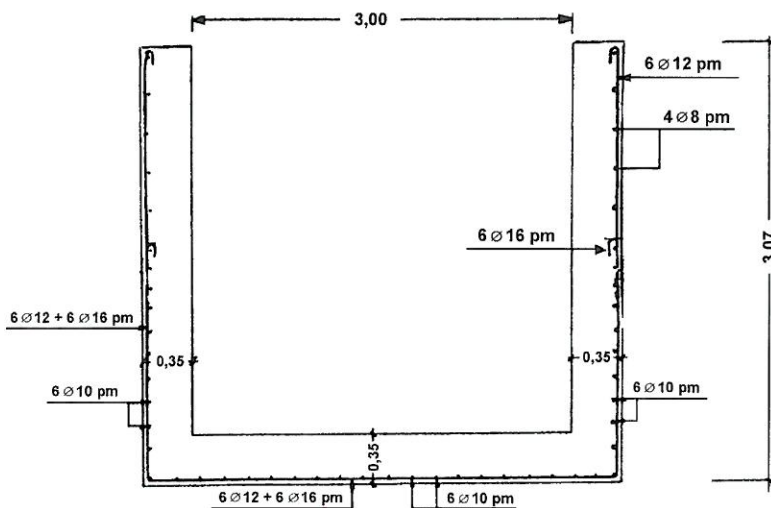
Disposição das armaduras nas paredes laterais e na soleira da escada
